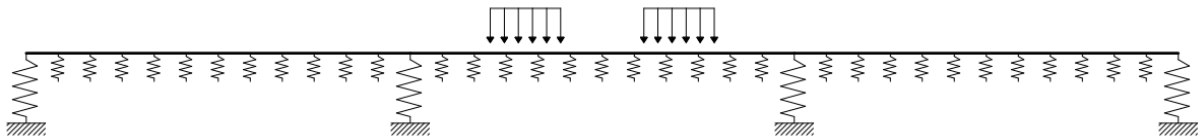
Stabwerkmodell des Längssystems mit Stabbettung und Federlagerung an den vier Querträgern
